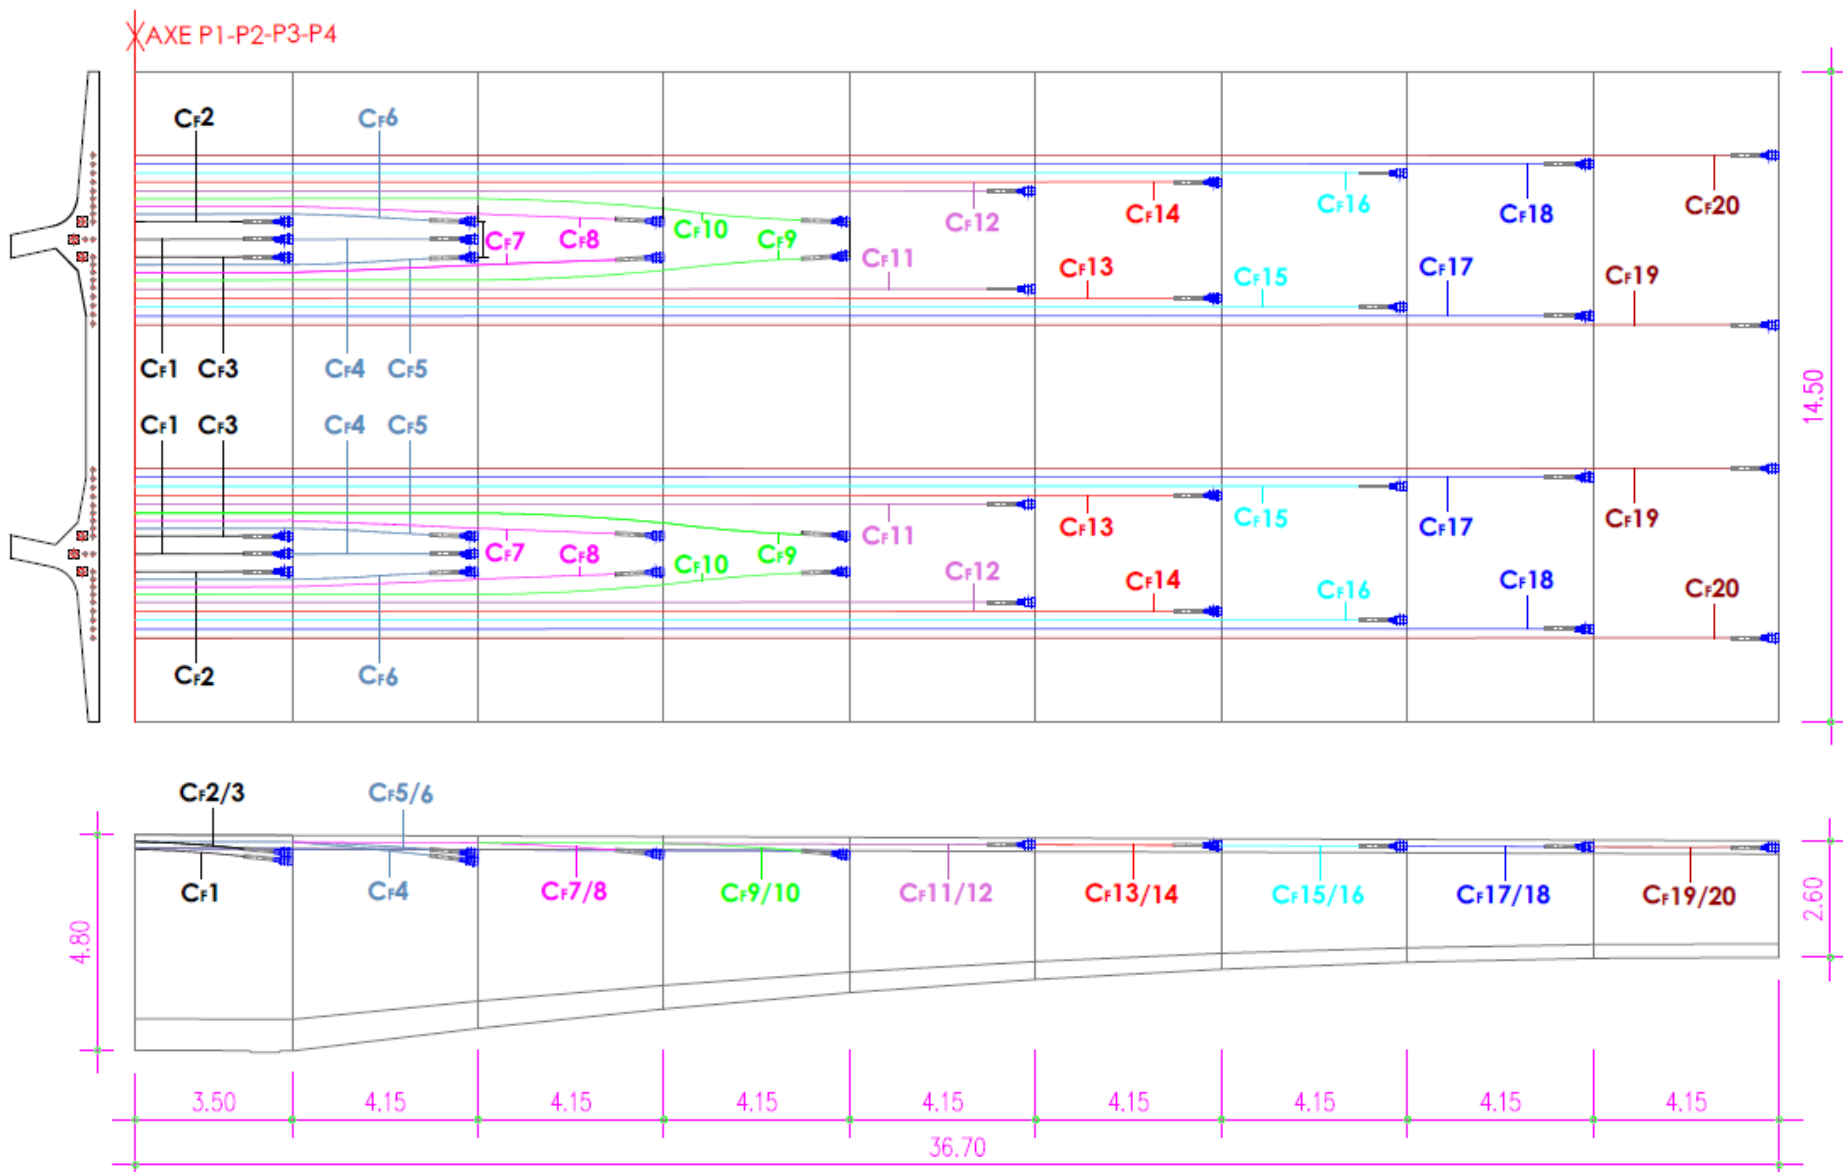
Tracé en élévation et en plan des câbles des fléaux P1/P2/P3/P4
